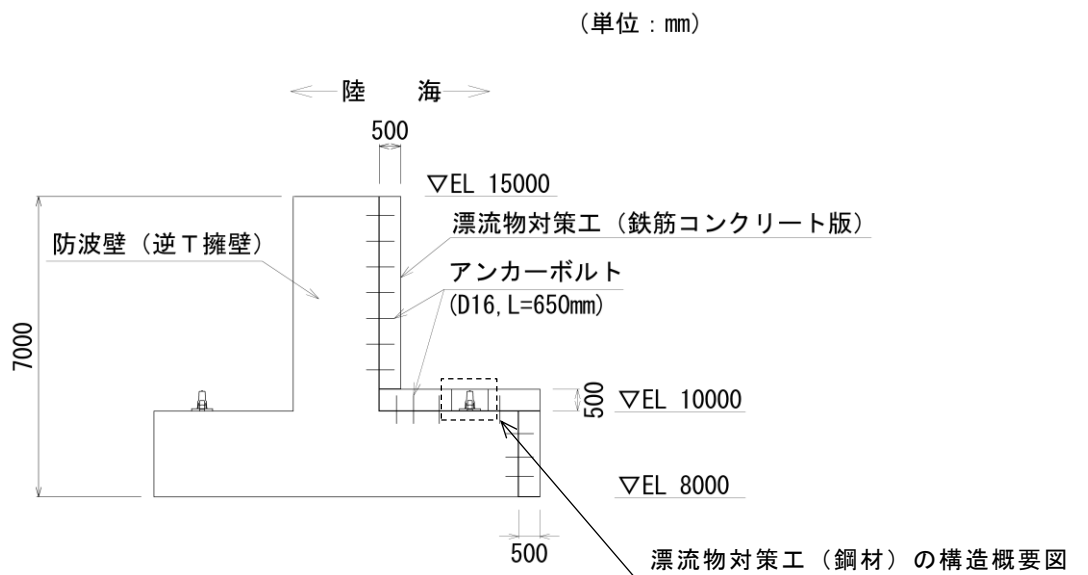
(2) 漂流物対策工 (鉄筋コンクリート版) のアンカーボルト配置図 (断面図)
